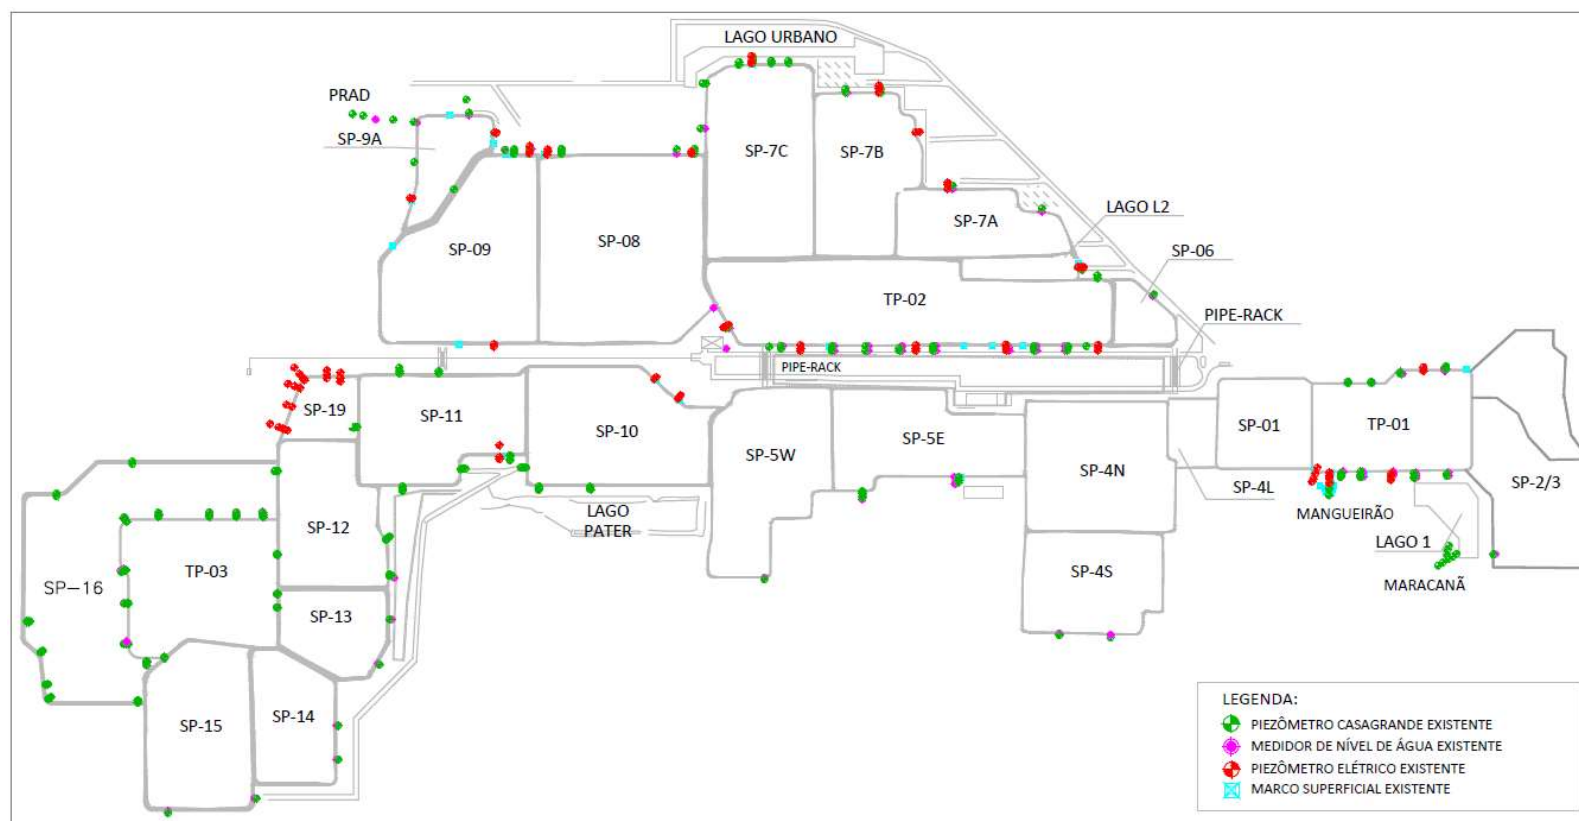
Planta esquemática de locação dos instrumentos existentes para as estruturas do Sistema de Rejeitos (SP's e TP's)
